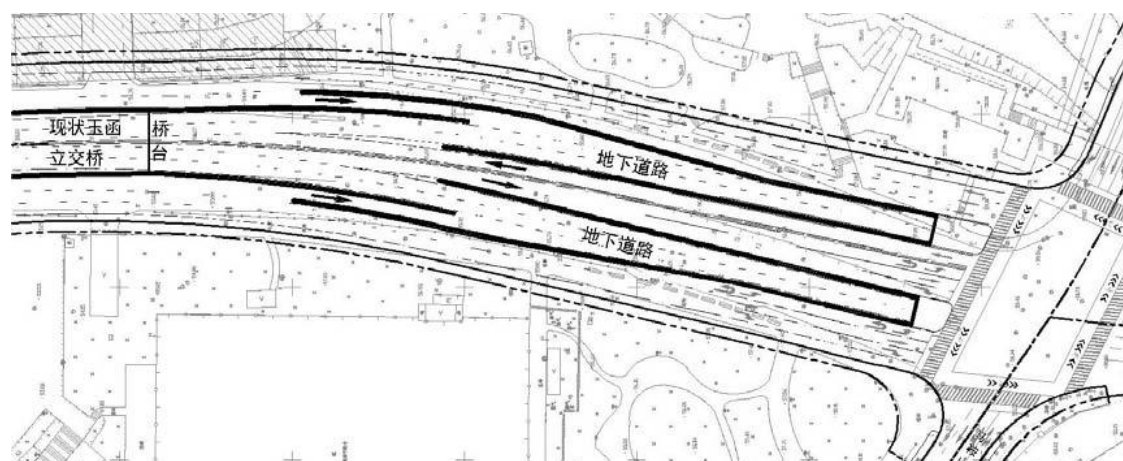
地下道路敞口段与玉函立交桥顺接平面布置图
